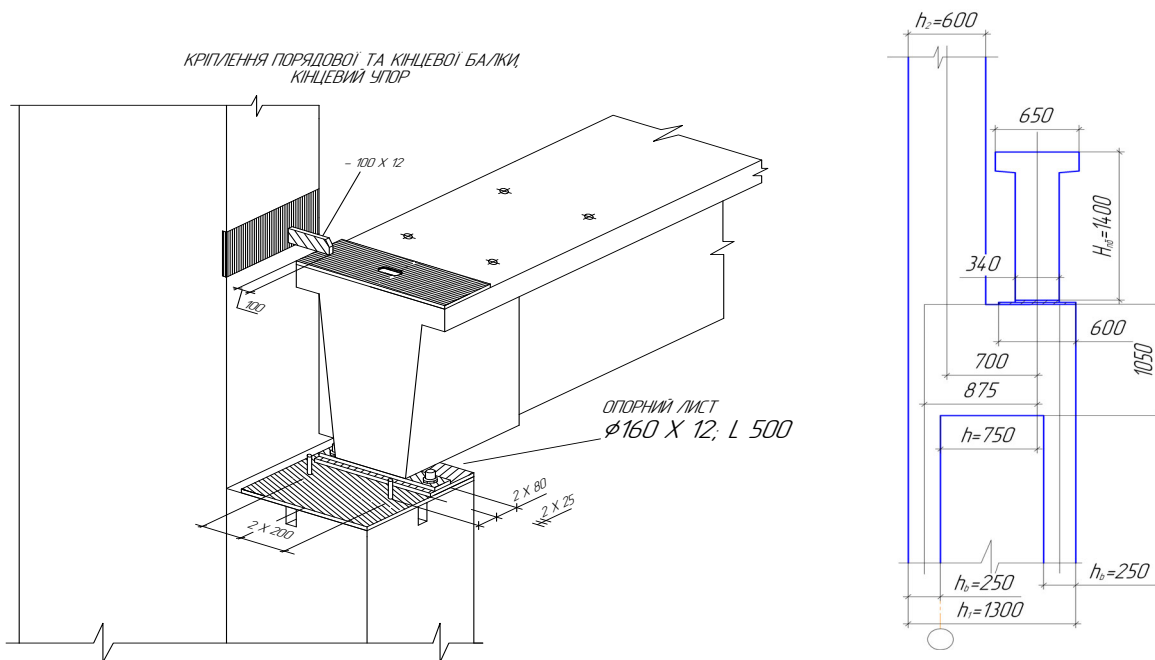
Фрагмент вузла колони надкранової, підкранової частини та з'єднання колони з підкрановою балкою
